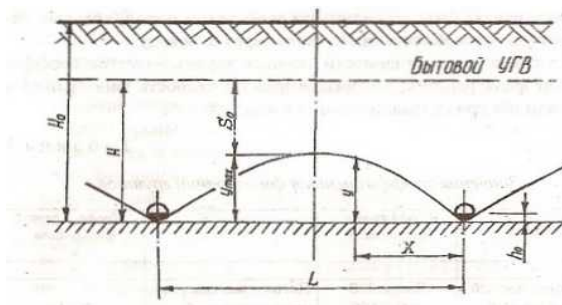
Схема к фильтрационному расчету систематического дренажа
